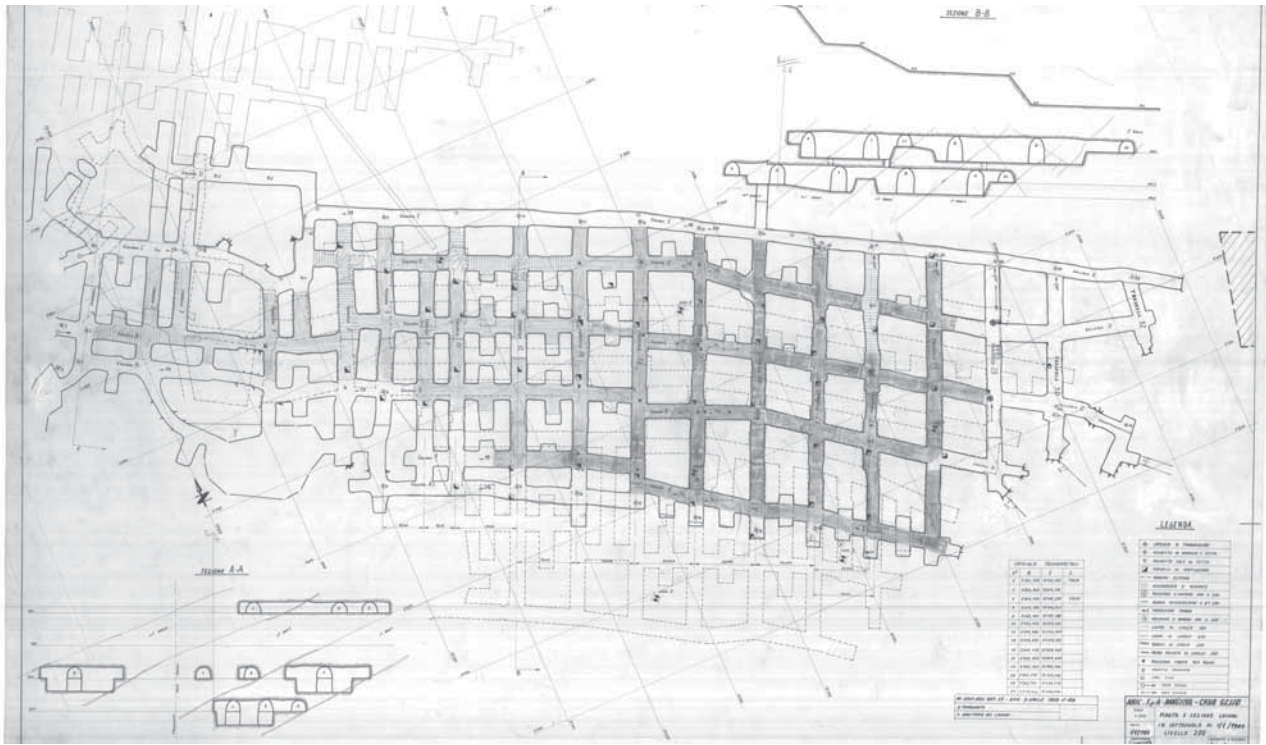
Cava di Monte Tondo: pianta e sezioni dei lavori in sotterraneo all'1 gennaio 1984; livello 200 (Archivio A. Olivier).
